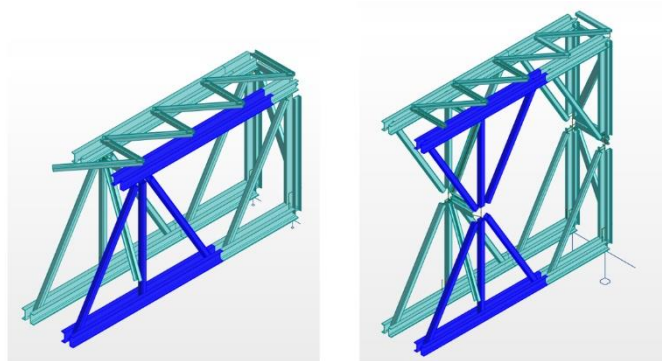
Módulos finais de vigas longitudinais de pontes com um e dois níveis de painéis, destacando a unidade modular básica de cada configuração.
